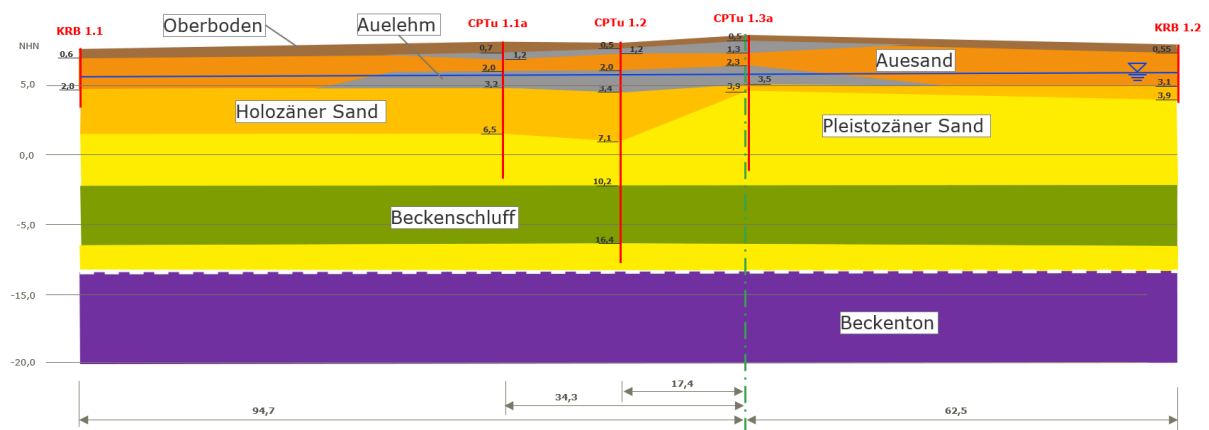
Lage der Baugrundaufschlüsse im Projektgebiet
